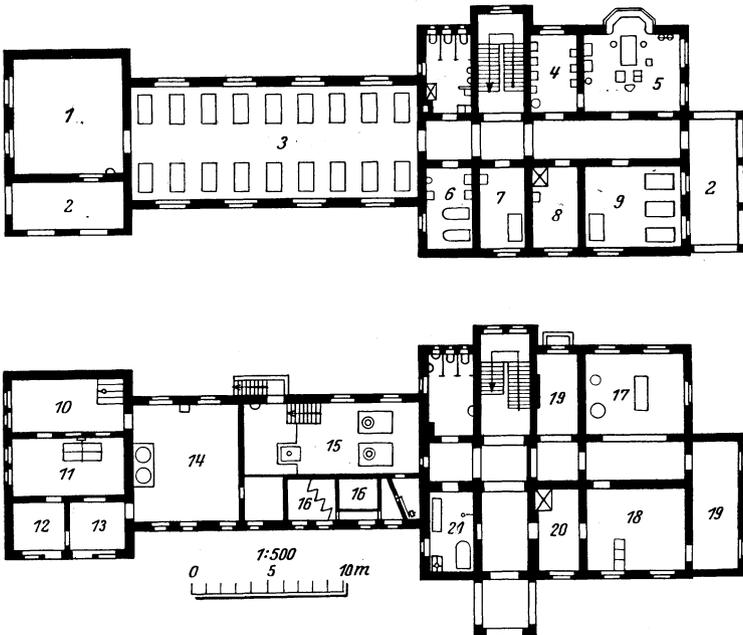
Petershofen O.-S. Knappschaftskrankenhaus, 80 Betten, Hauptgebäude, Ober- u. Erdgeschoß.
